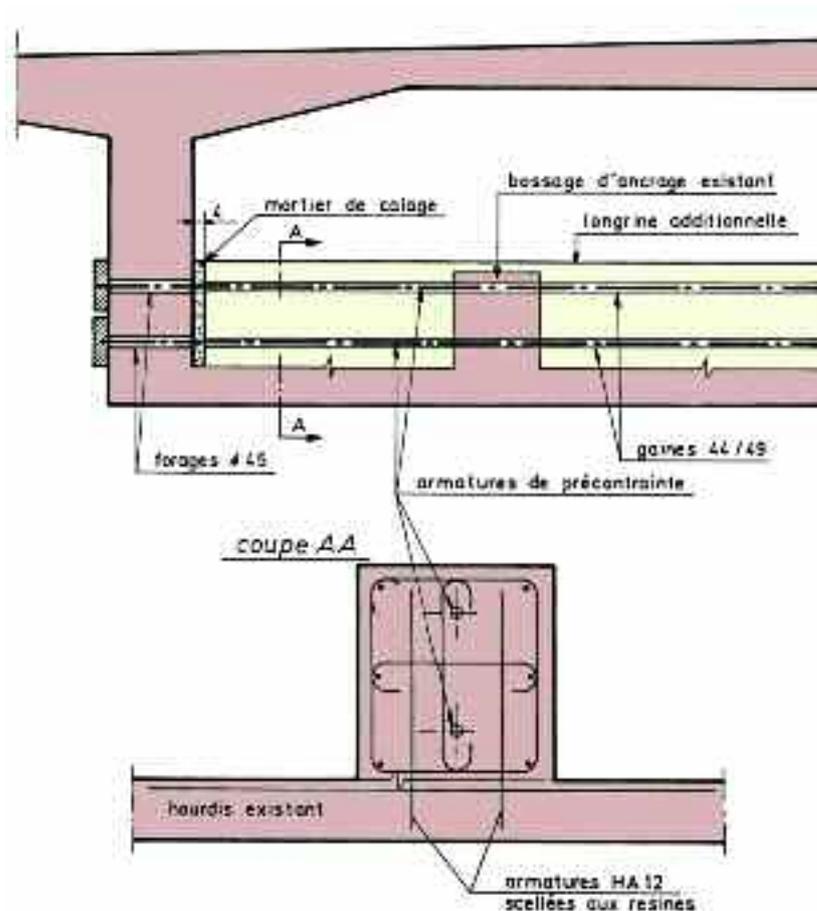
principes de construction de nervures transversales bloquées sur les âmes
